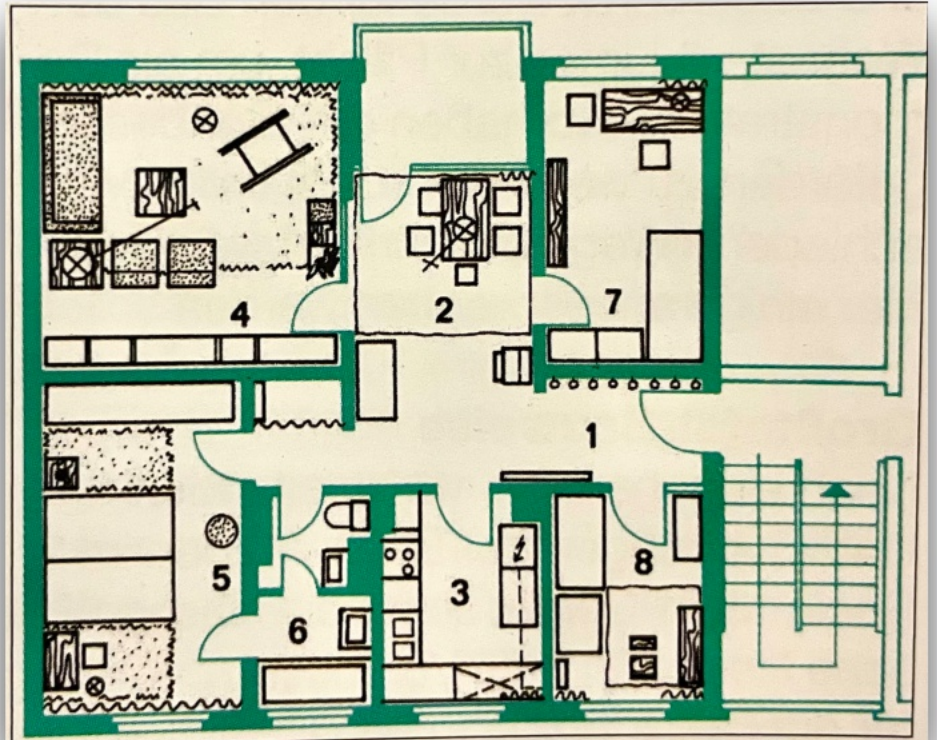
Grundriss einer 3 1/2 Zimmer - Wohnung
